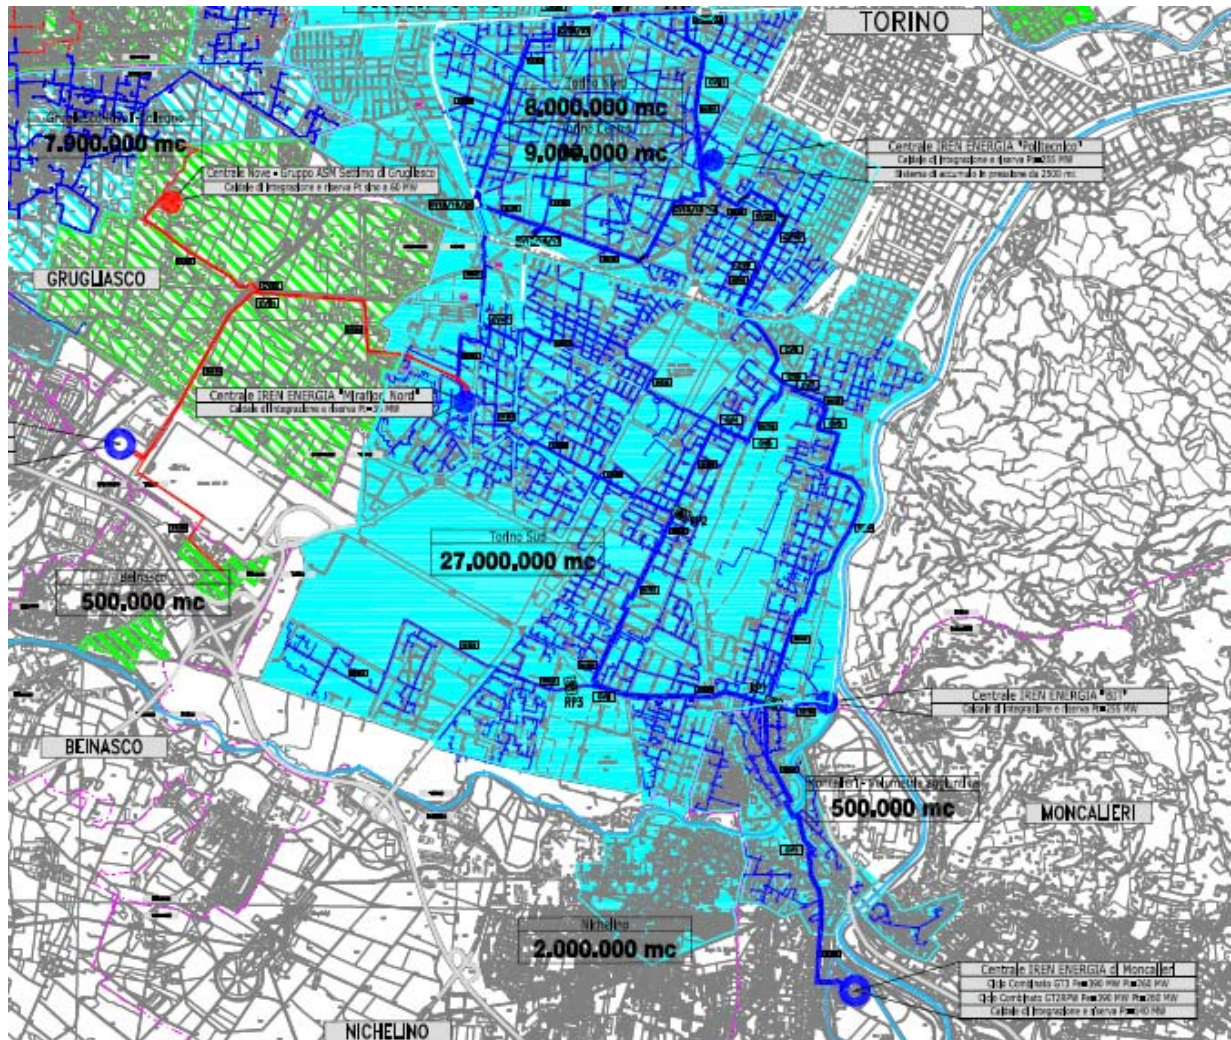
Planimetria generale, rete di teleriscaldamento e aree servite
